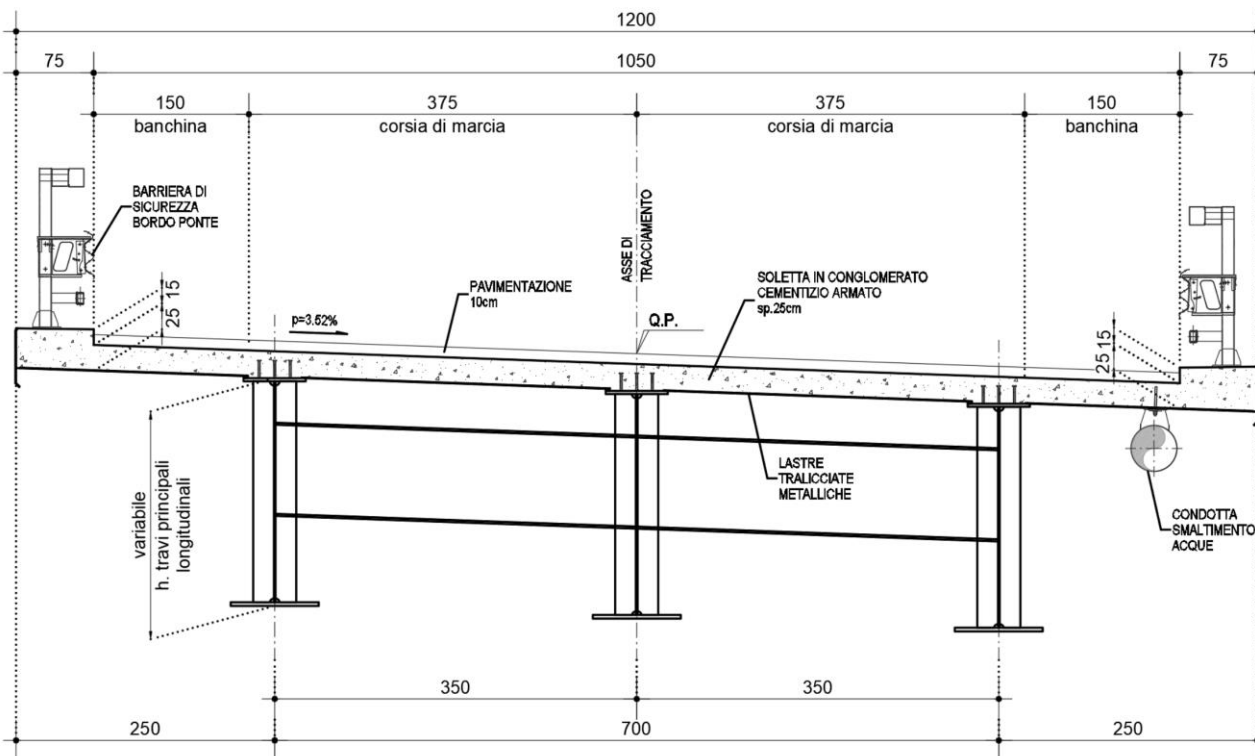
Sezione trasversale tipo impalcato (Cat. C1)
